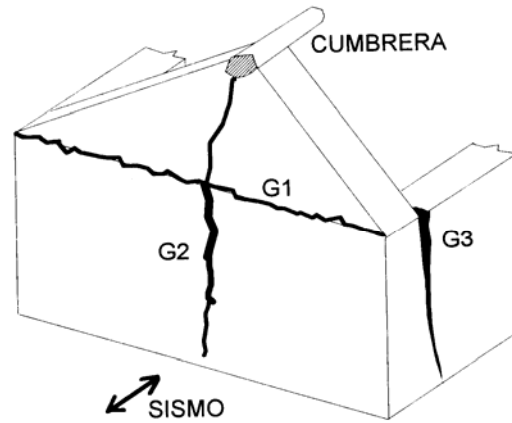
Grietas por acciones sísmicas perpendiculares al muro (Ref.1)
